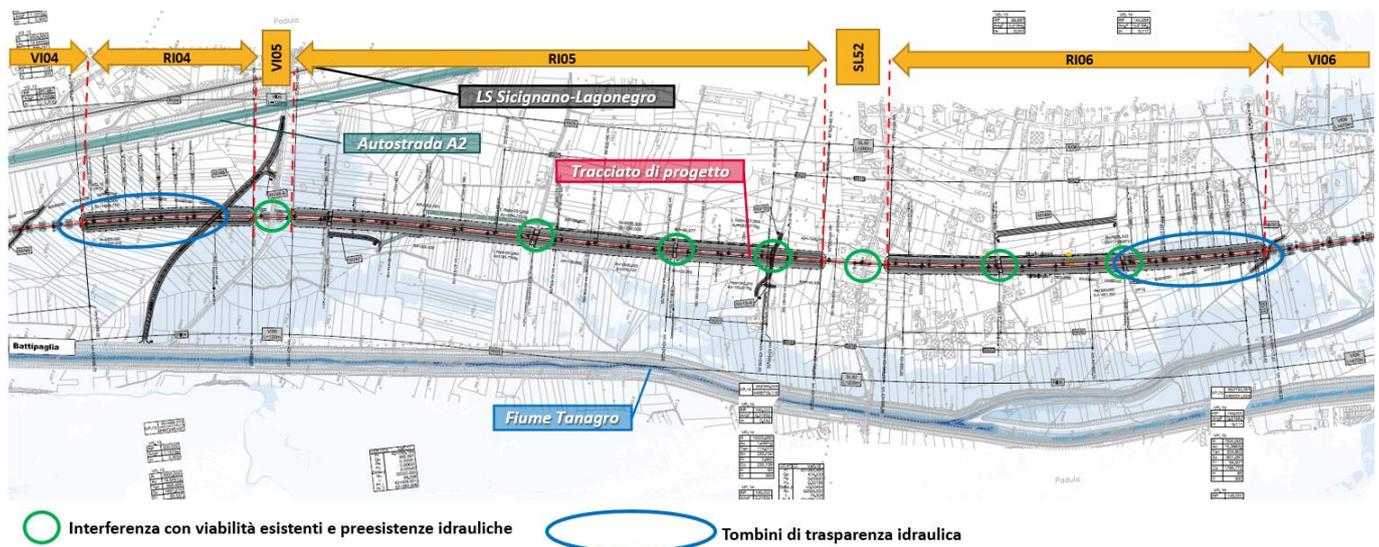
Planimetria aree allagabili da km 41+486 a km 45+026
